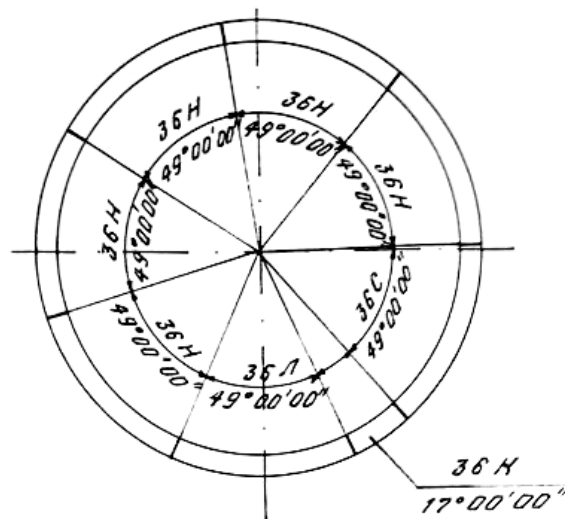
Обделка из обжатых в породе железобетонных элементов до фактически разработанного контура грунта
